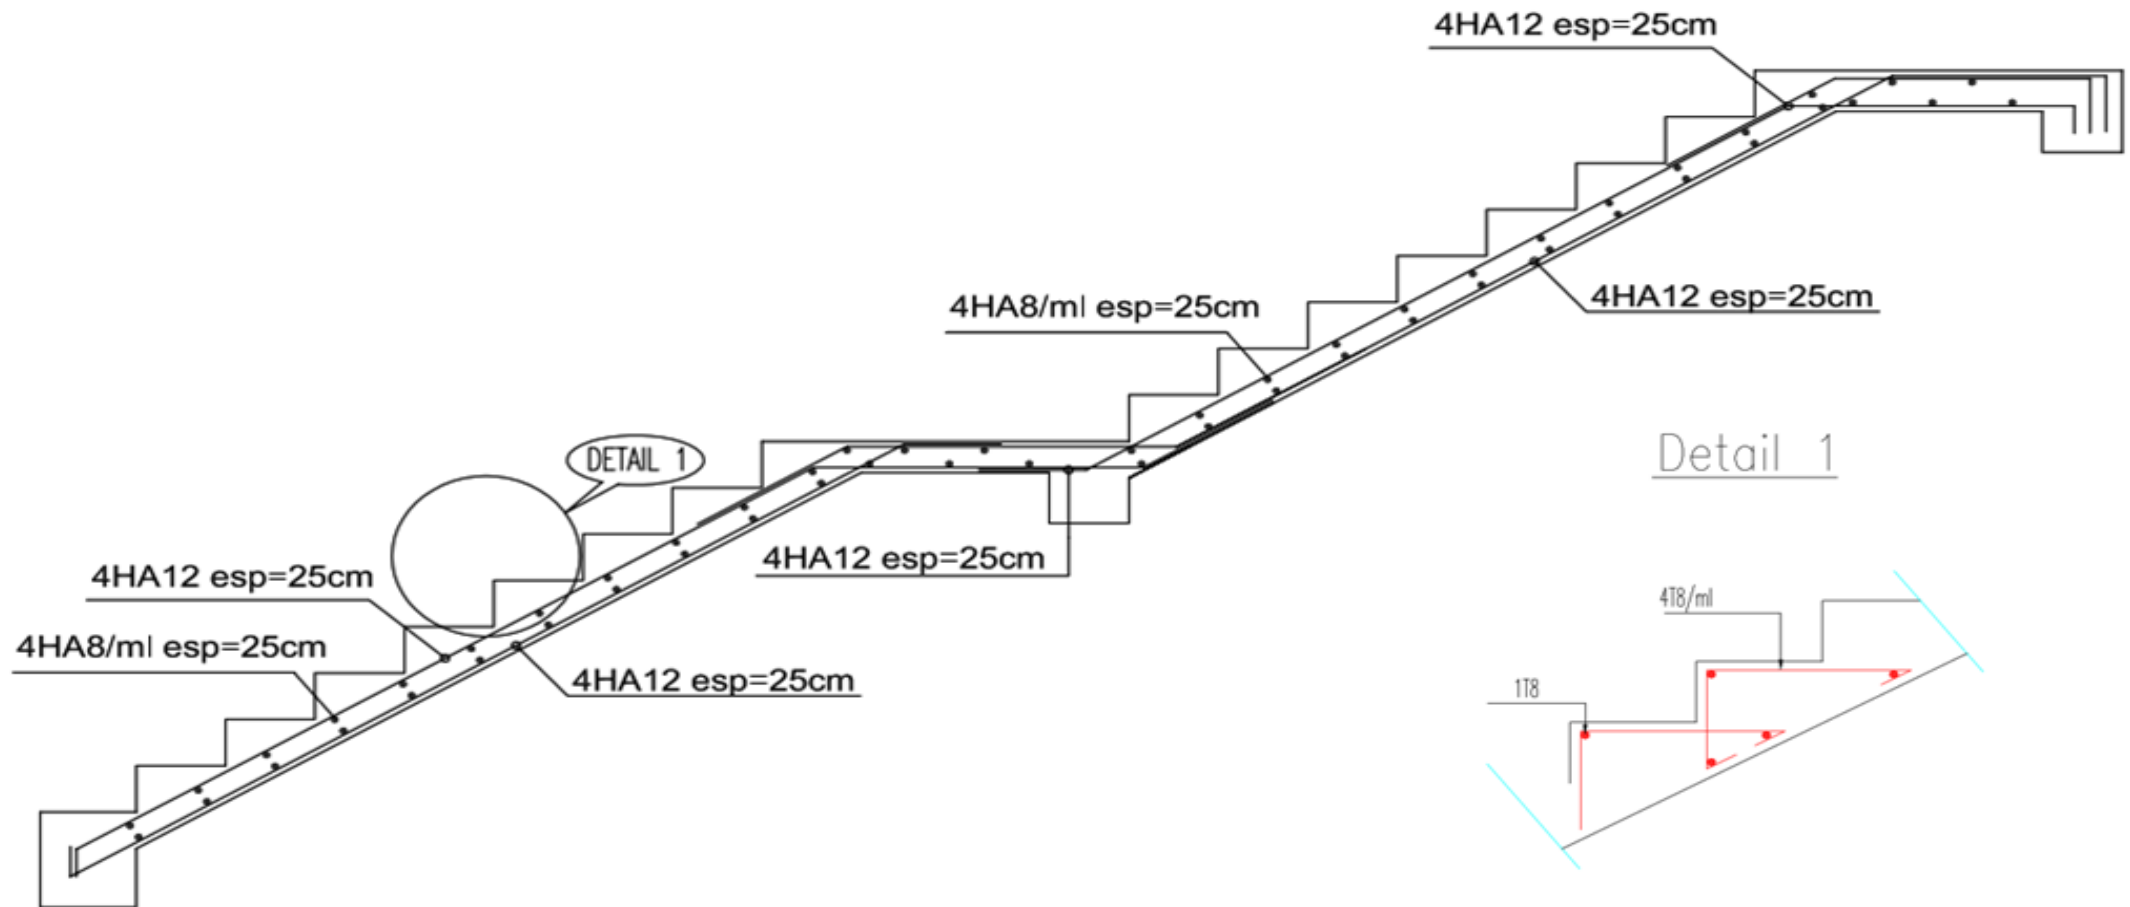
Ferrailage de l'escalier -2- du R.D.C.
